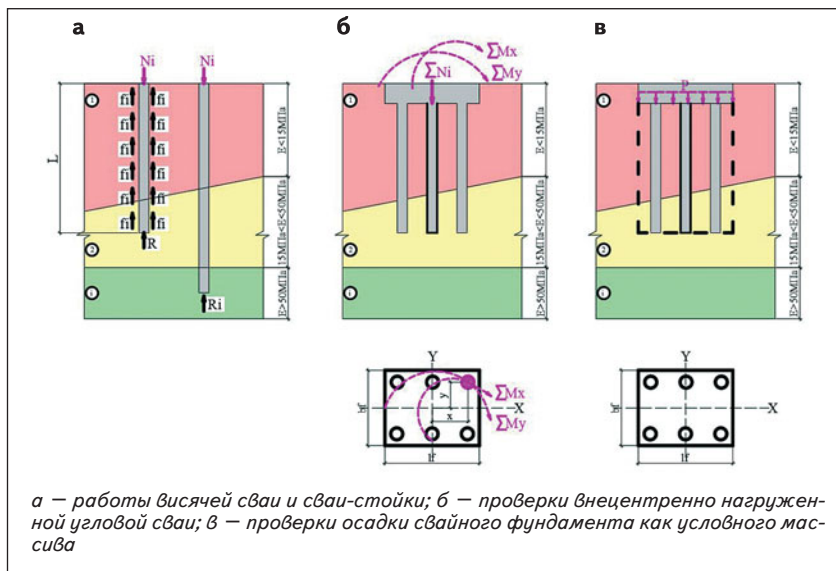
Схемы для расчетных проверок фундаментов глубокого заложения
